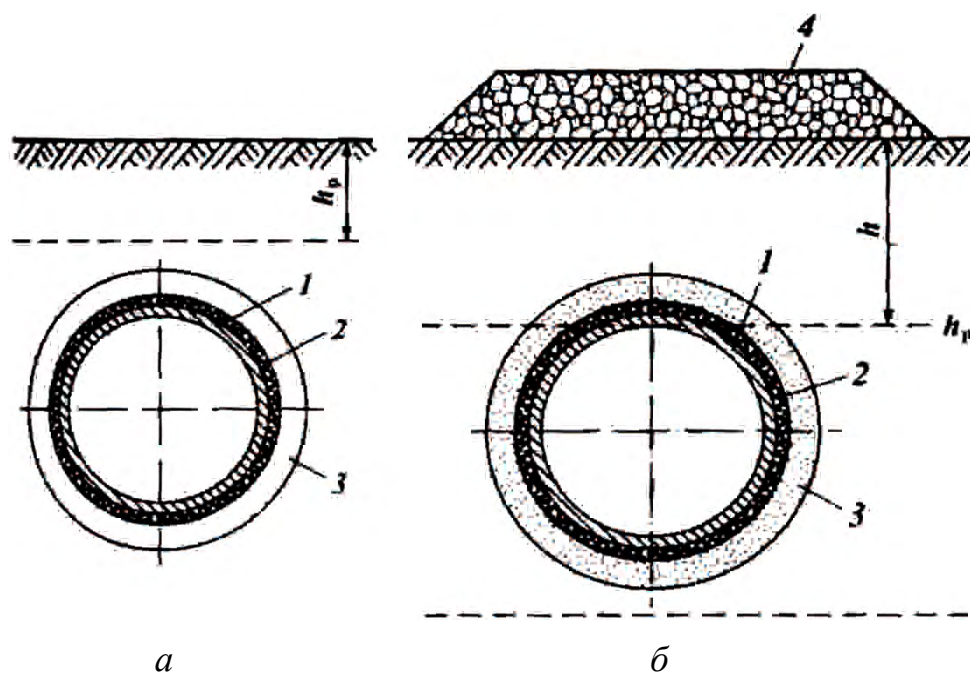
Схема заглубленного трубопровода: *a* — укладка ниже глубины размыва грунта; *б* — укладка на глубине размыва грунта: 1 — труба; 2 — изоляция; 3 — утяжеляющее покрытие; 4 — каменная наброска
